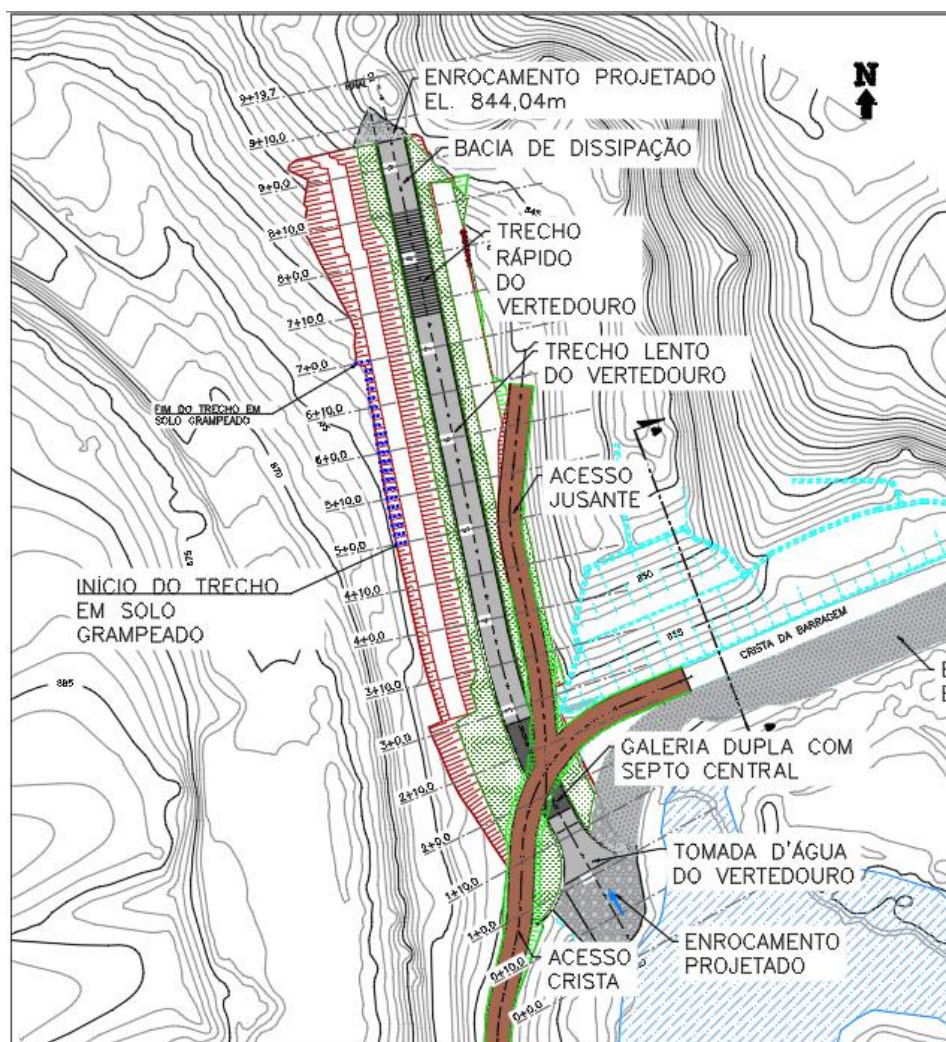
Planta com a localização das seções transversais (Estaca 0+10,00 a 9+0,00)
